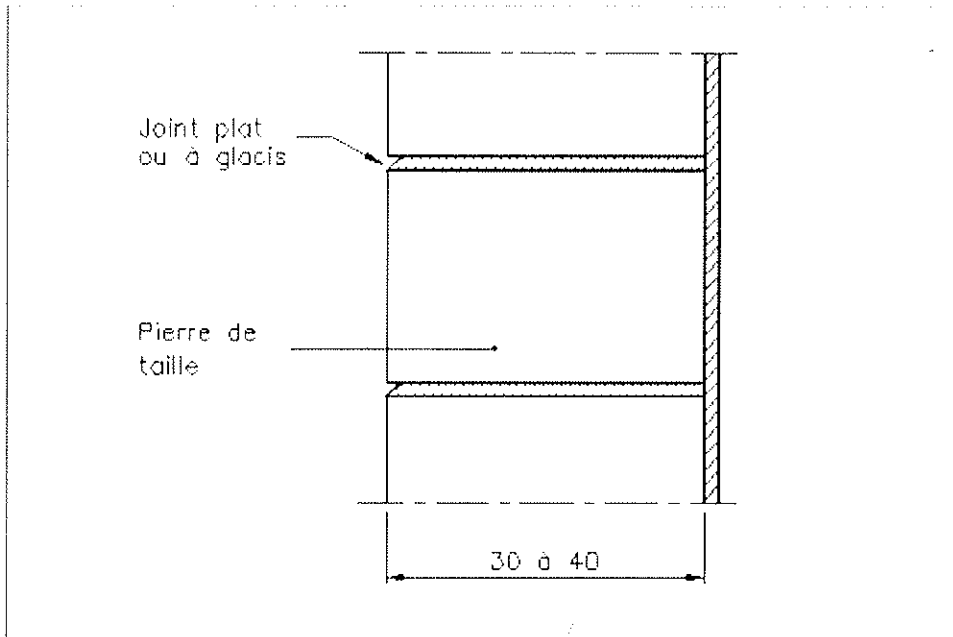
Moellons taillés ou pierre de taille/murs du type I en pierre/épaisseurs minimales
